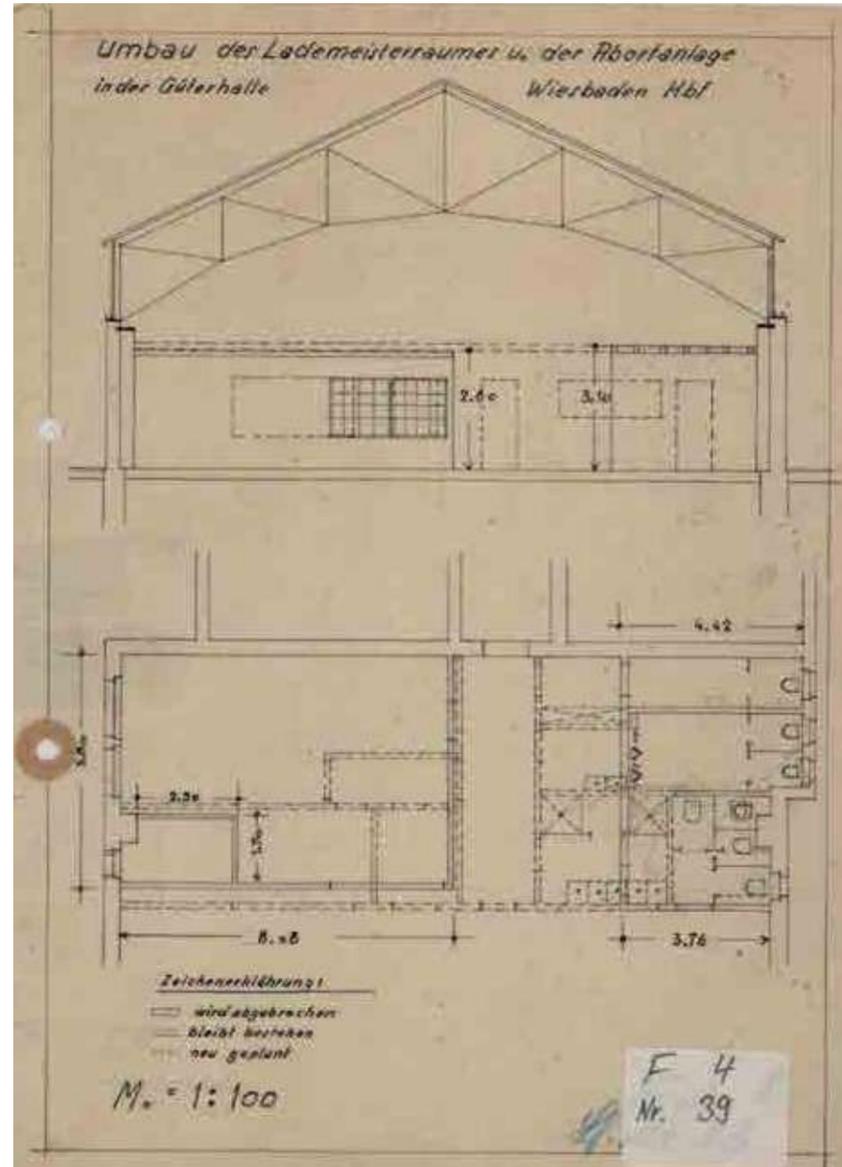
Stückgutschuppen: Plan für den Umbau des Lademeisterraumes und der Abortanlage, 1957
